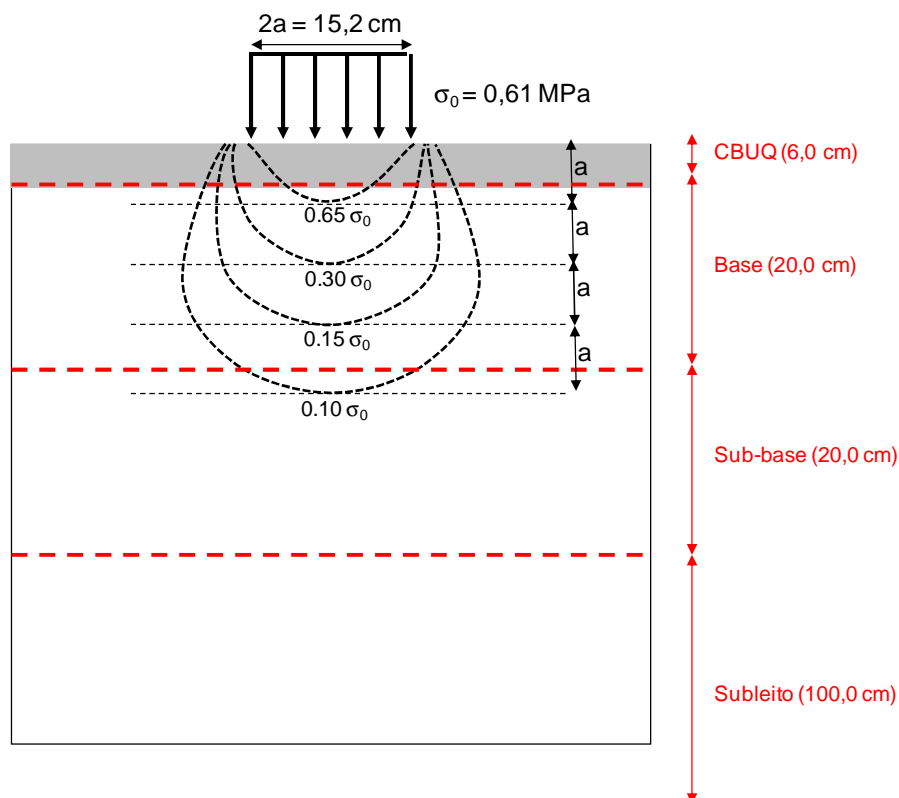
Esquema do bulbo de pressão aplicado às condições de carregamento no pavimento do tanque-teste.
